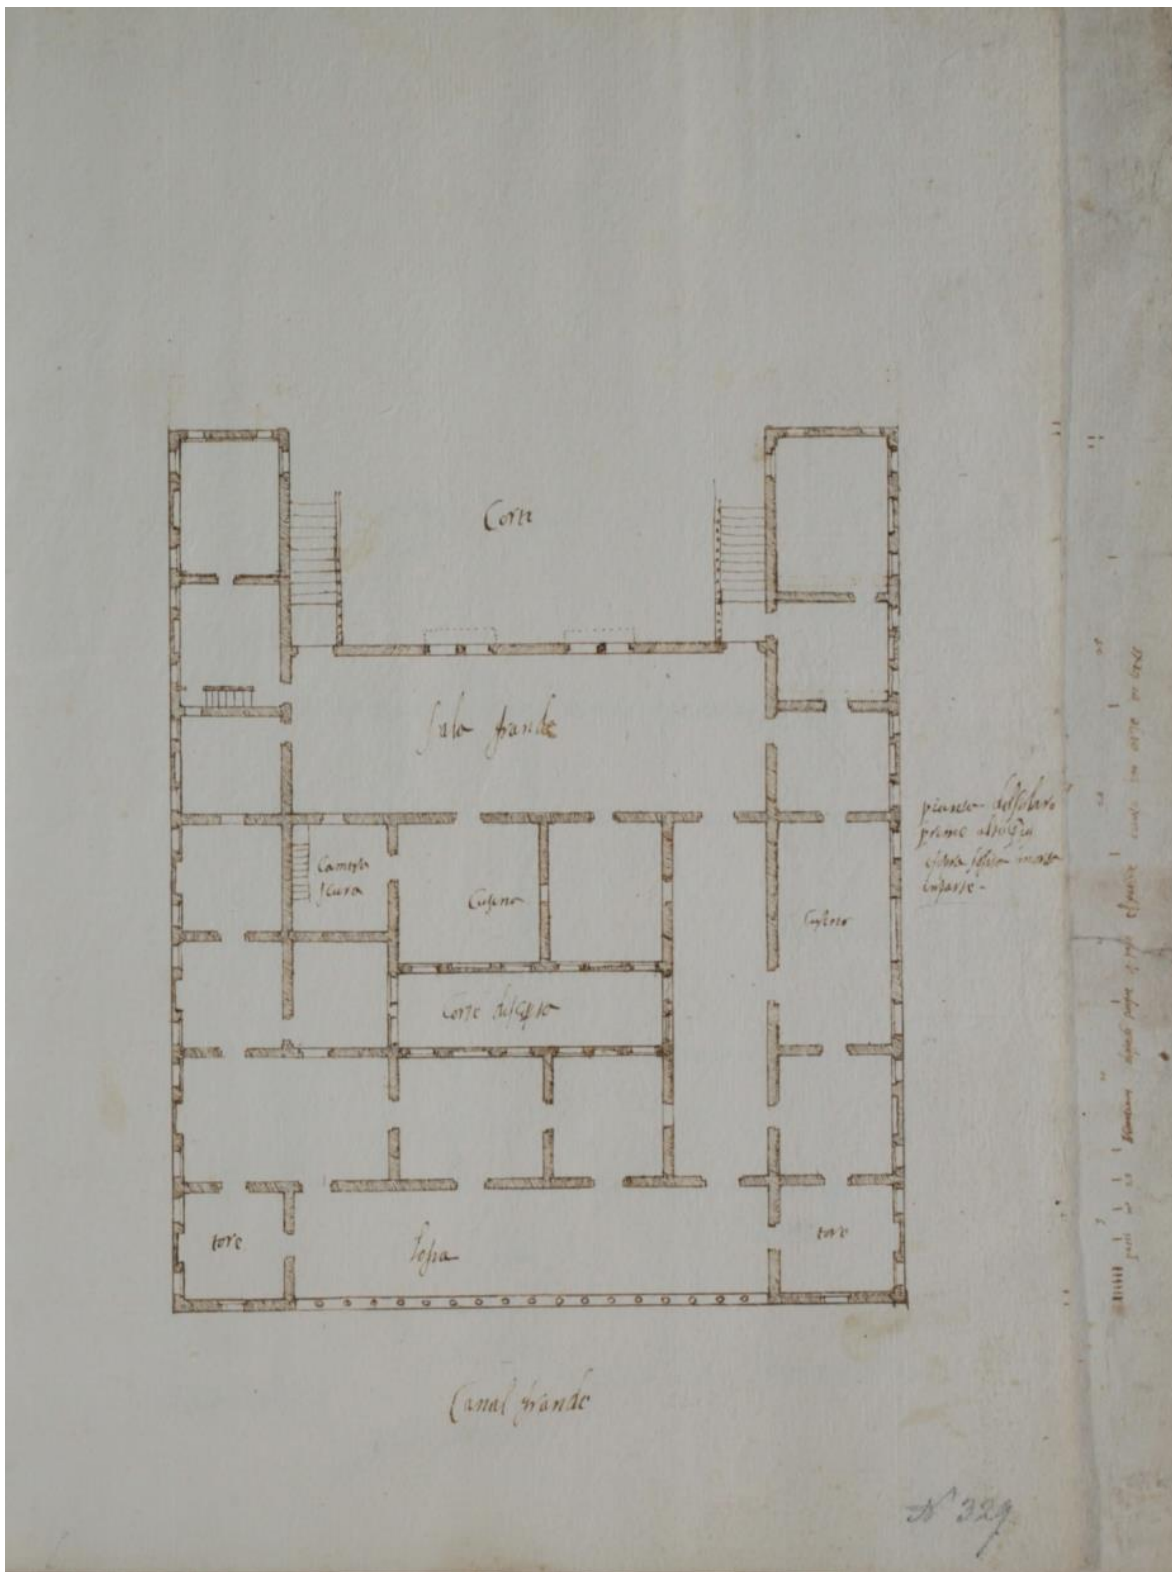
9 Cesare Torello, *Pianta del Palazzo già Pesaro poi dei Marchesi e Duchi d'Este* – first-floor plan, ca. 1600.
